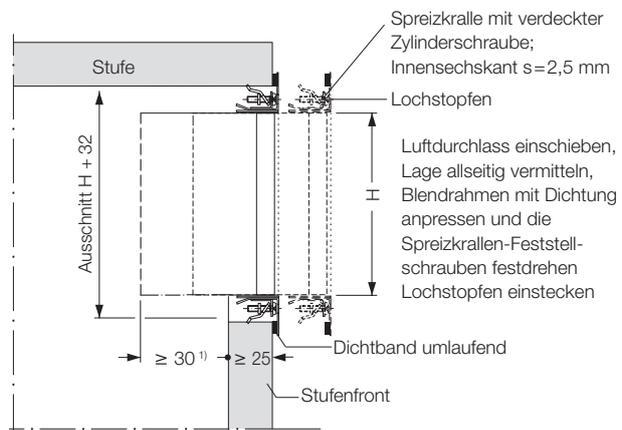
Ausführung mit Blendrahmen für Spreizkrallenbefestigung
